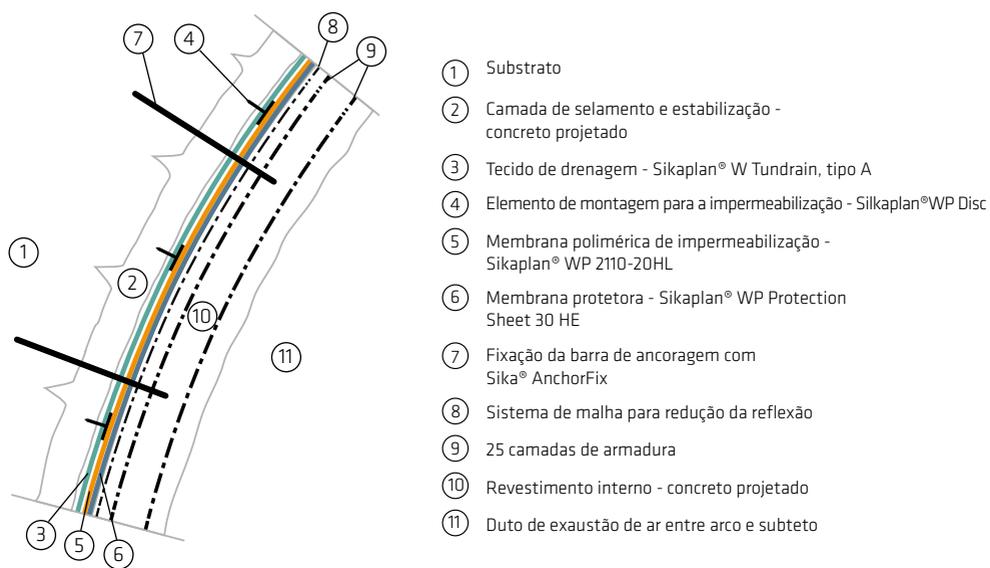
Revestimento de túnel em double-shell com concreto projetado
